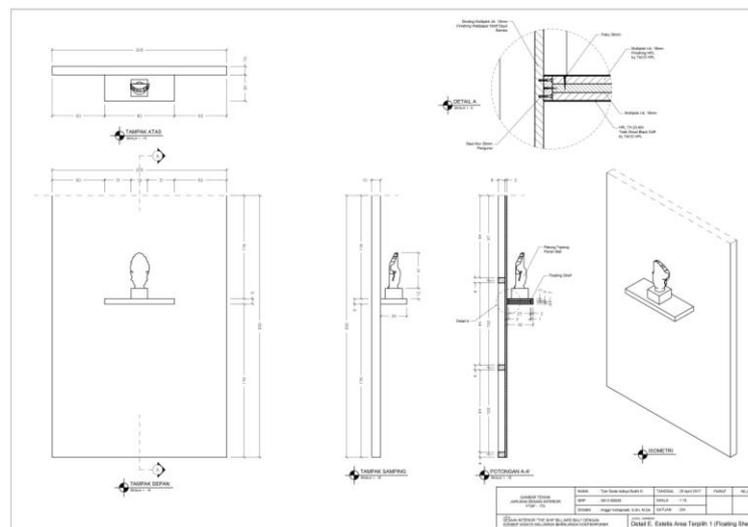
11 Detail Furnitur Area Terpilih 1
